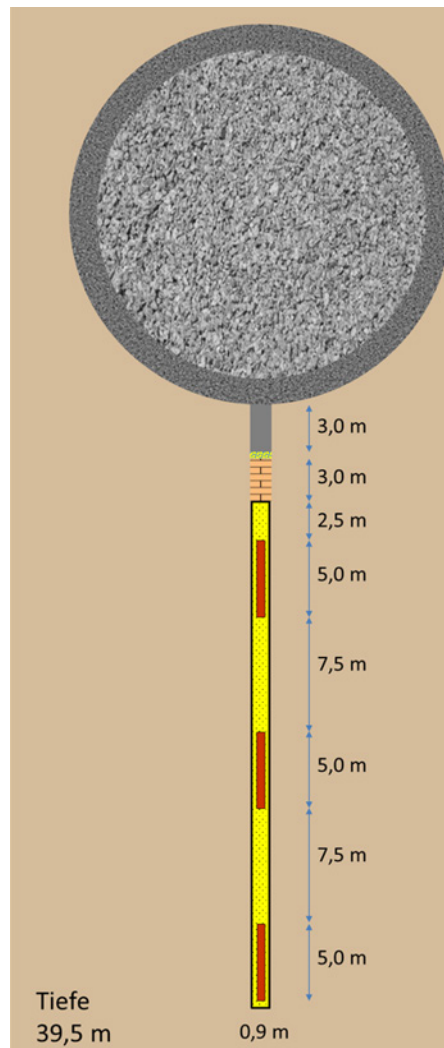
Schematische Darstellung eines Einlagerungsbohrlochs (Wunderlich et al. 2022) mit den Elementen: mit Versatz verfüllte Bohrlochüberfahrungsstrecke mit Beton-Support (grau), Rückholbare Kokille (rot), Sand (gelb), Bentonit-Element (orange)
